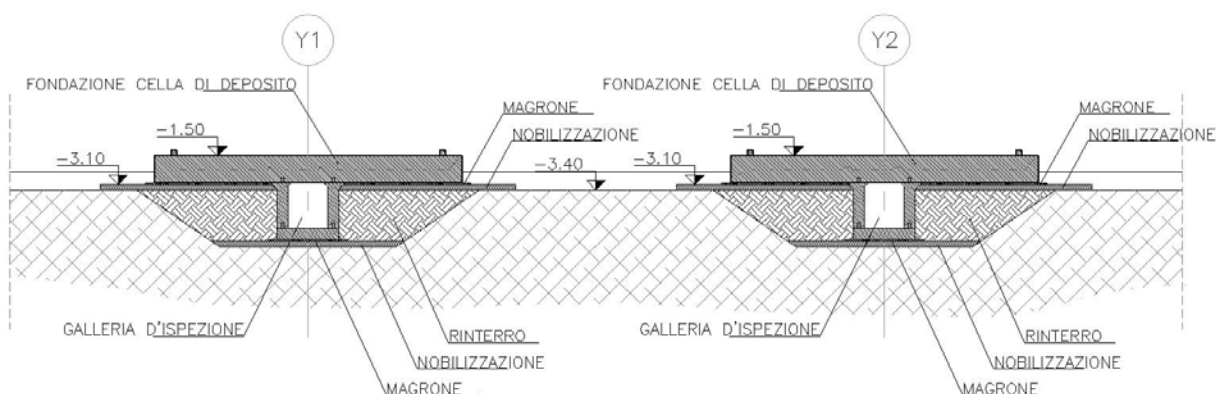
Sezione trasversale fondazioni Cella di Deposito
